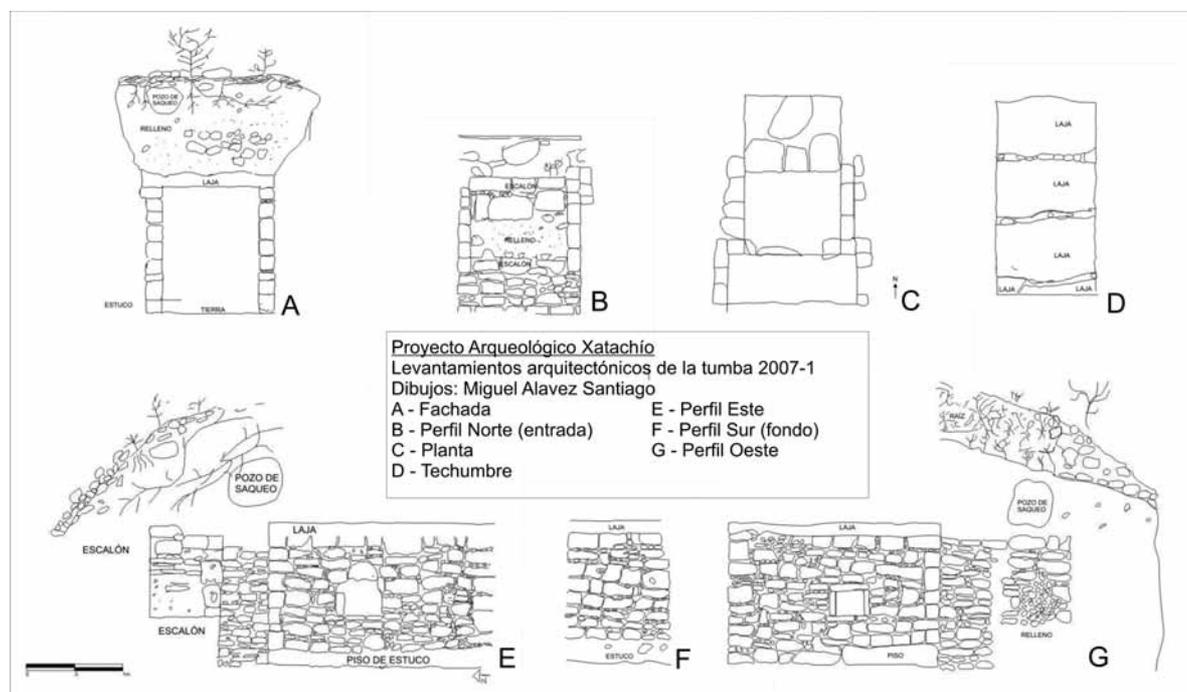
Levantamientos arquitectónicos de la tumba explorada.
